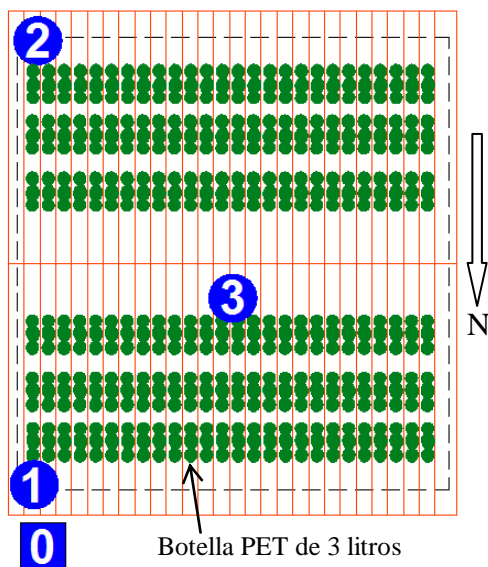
Ubicación acelerómetros. Vivienda Con Techo Verde. Vista: Top
